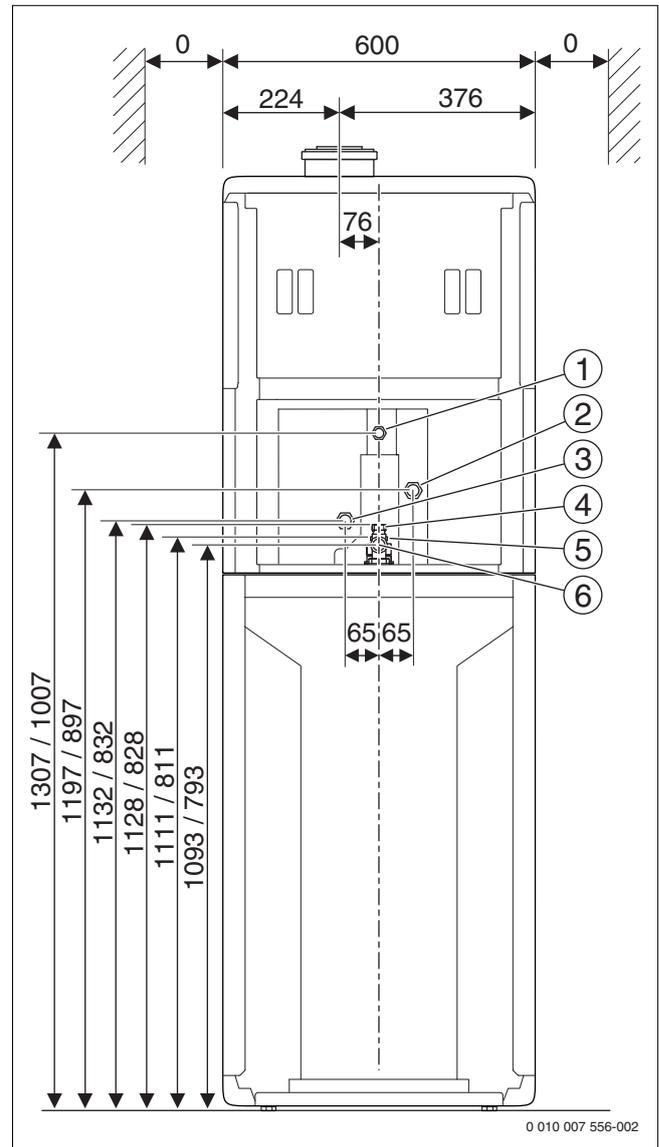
Abmessungen und Anschlüsse ohne Zubehör
